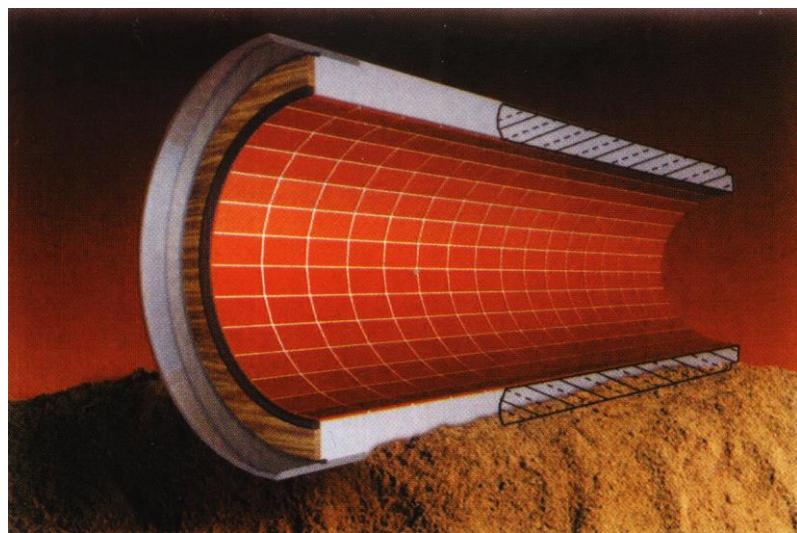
Железобетонные трубы с внутренним керамическим покрытием из плиток
